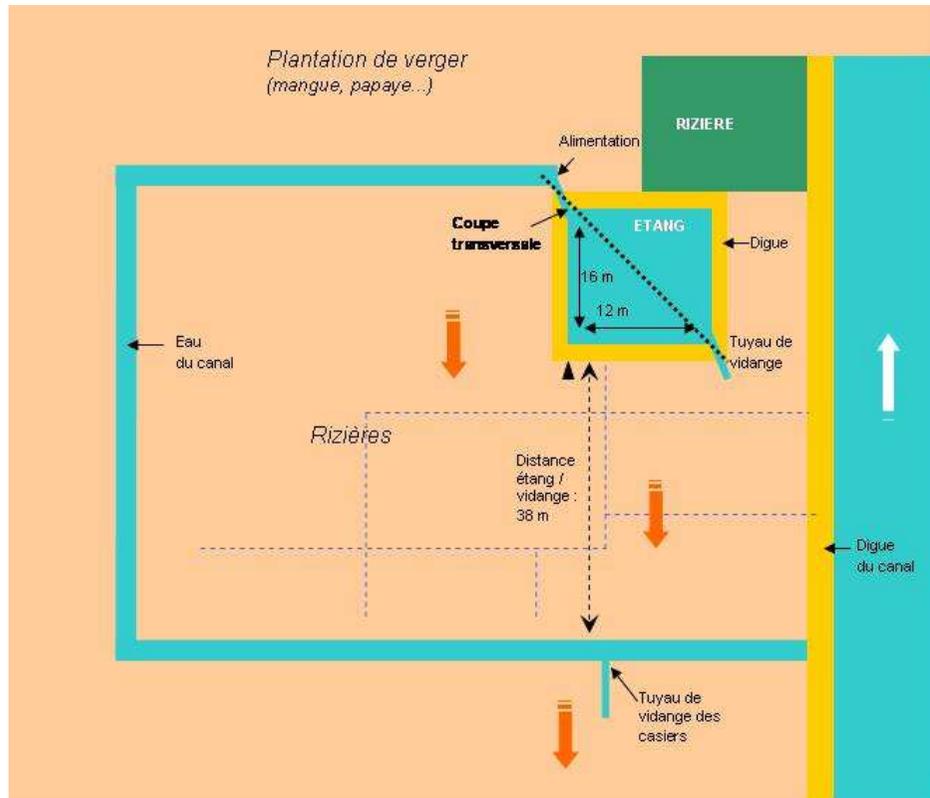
Vue du dessus de l'aménagement de Flany Coulibaly
